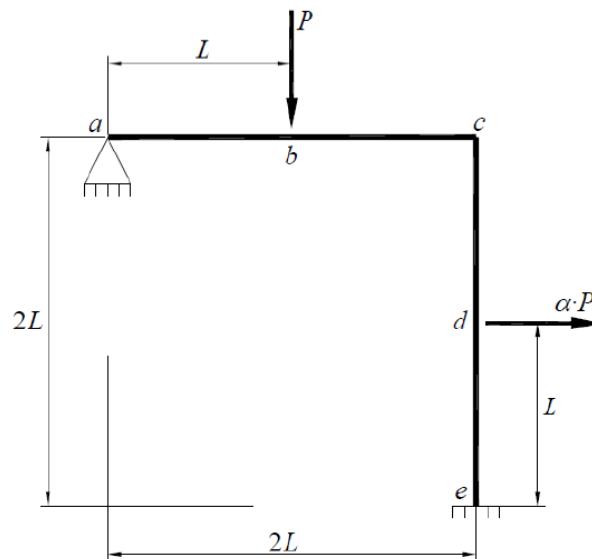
Estructura para cálculo plástico del problema 5.2
